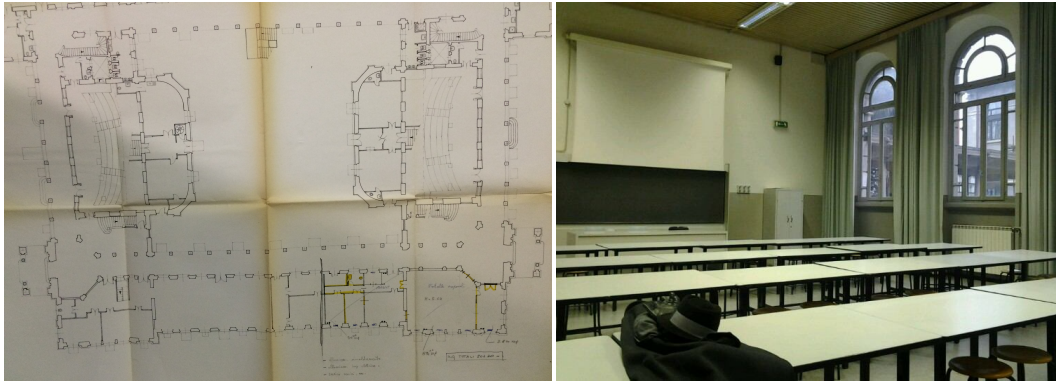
foto del progetto del piano soppalco (anni 80); foto recente di un'aula (a destra)
